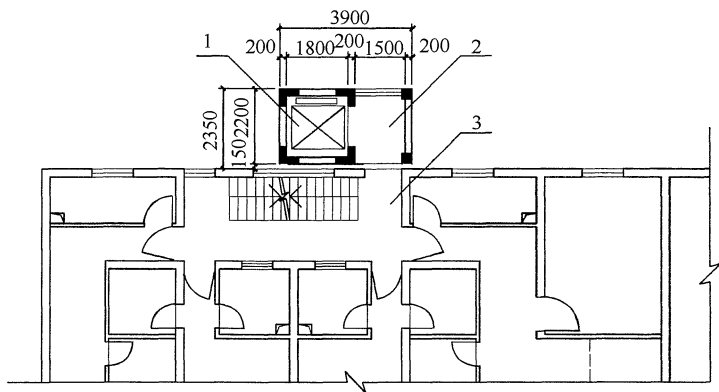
人流平层入户电梯布置示意图（标注单位：mm）
